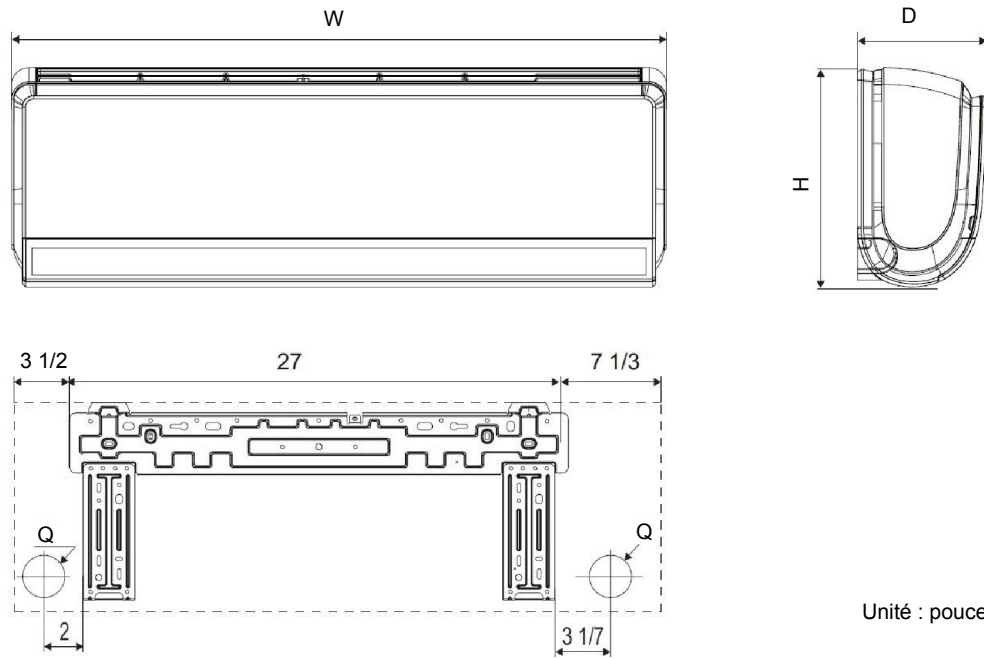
40GRQ/619FB – Dimensions du montage en hauteur
